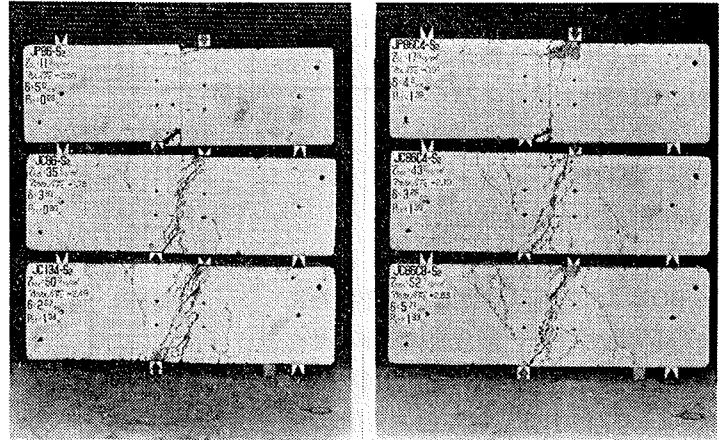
最終破壊状況 (S_2 シリーズ: 6 体)
